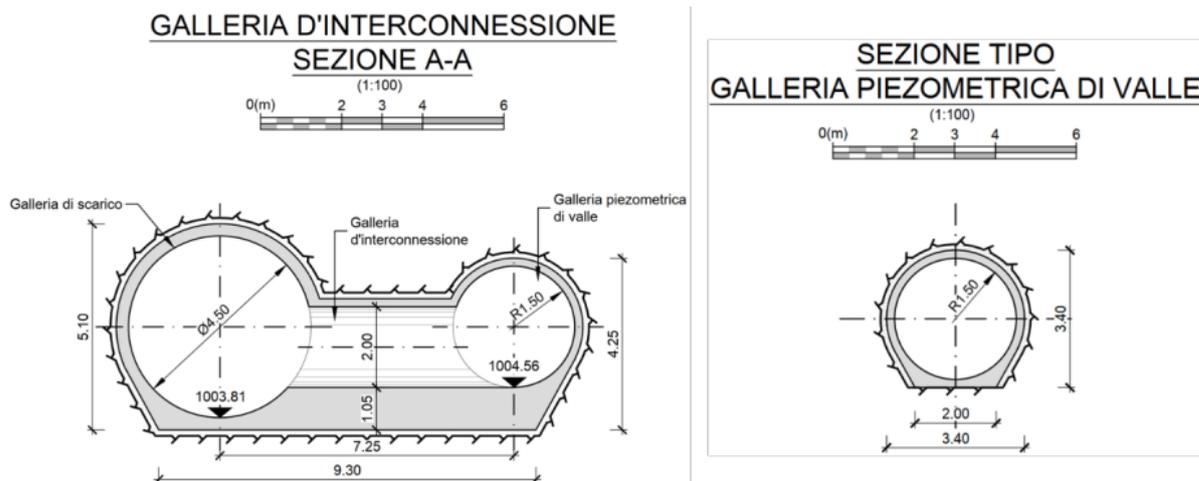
Nuovo pozzo piezometrico sulla derivazione Provvidenza – sezione camera d'interconnessione con stacco da galleria di scarico esistente e sezione tipo pozzo piezometrico
